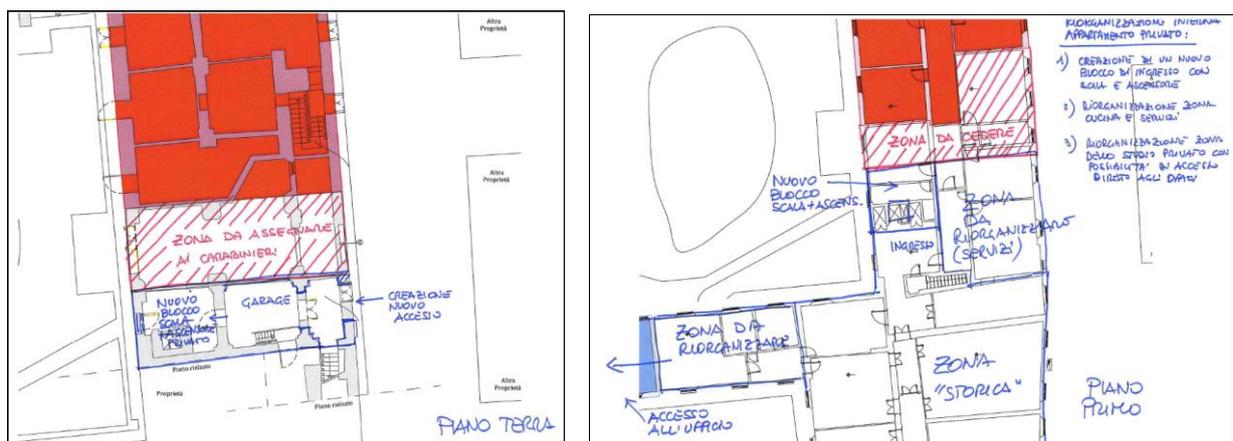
schematizzazione degli interventi da prevedere in corrispondenza della zona di confine tra alloggio prefettizio e porzione in uso all'Arma dei Carabinieri sul versante est
